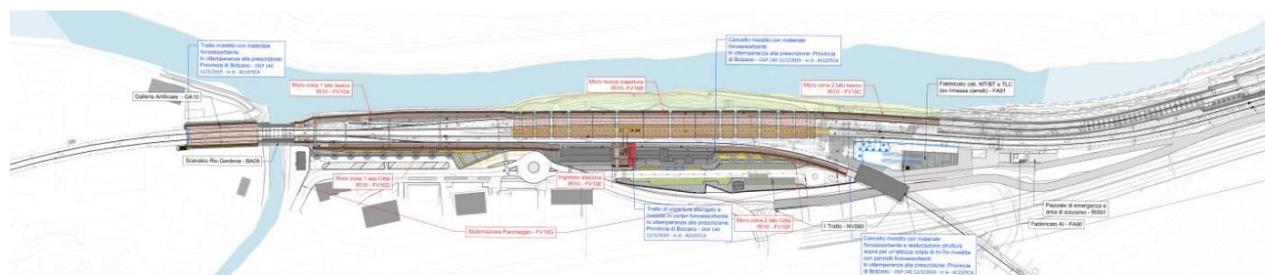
Interventi a Ponte Gardena: planimetria generale tratto STAZIONE
